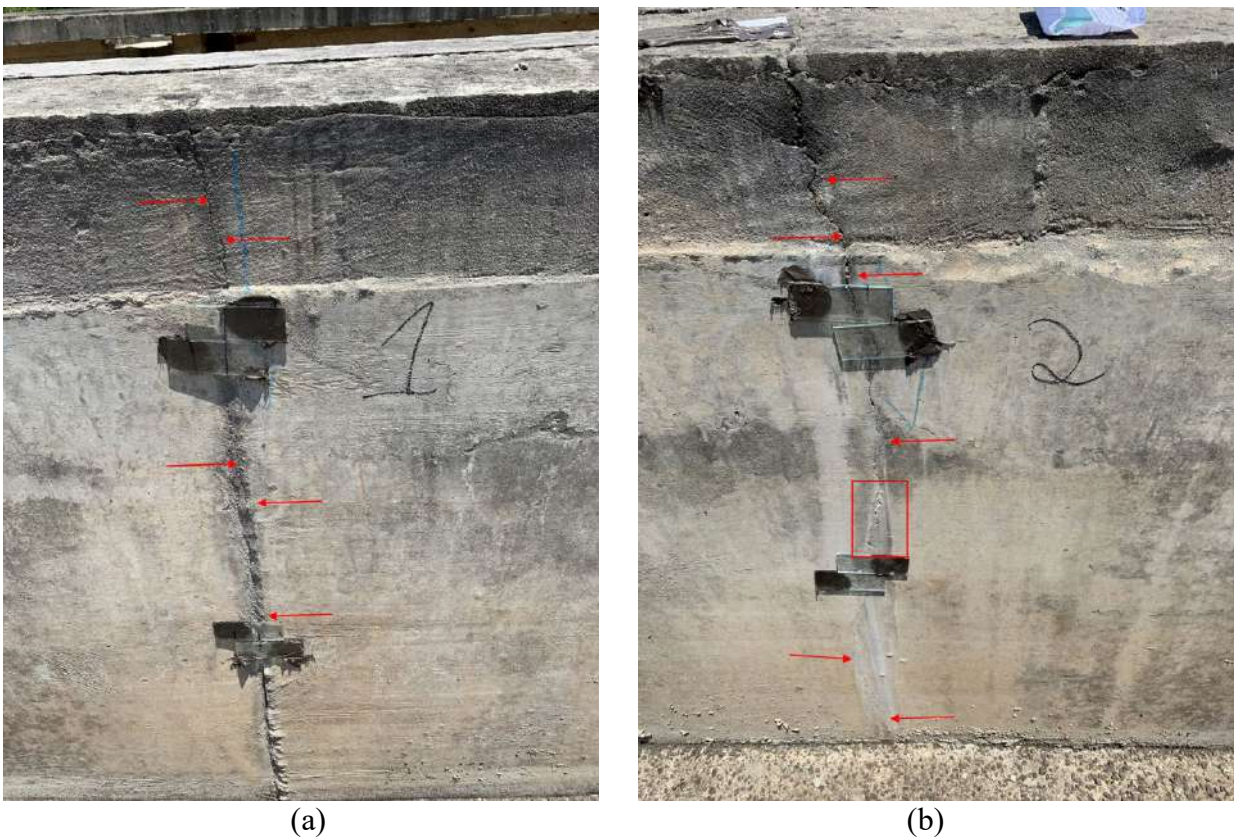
(a) Fissuras 1 e (b) 2 verticais na parede 3
